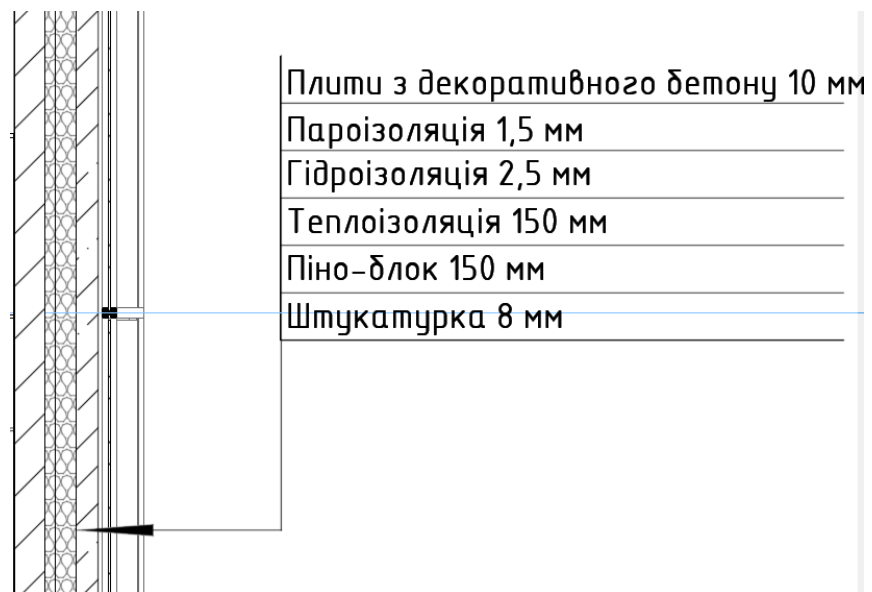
Конструктивне рішення стіни будівлі, з переформованими панелями, бетонними плитами.
